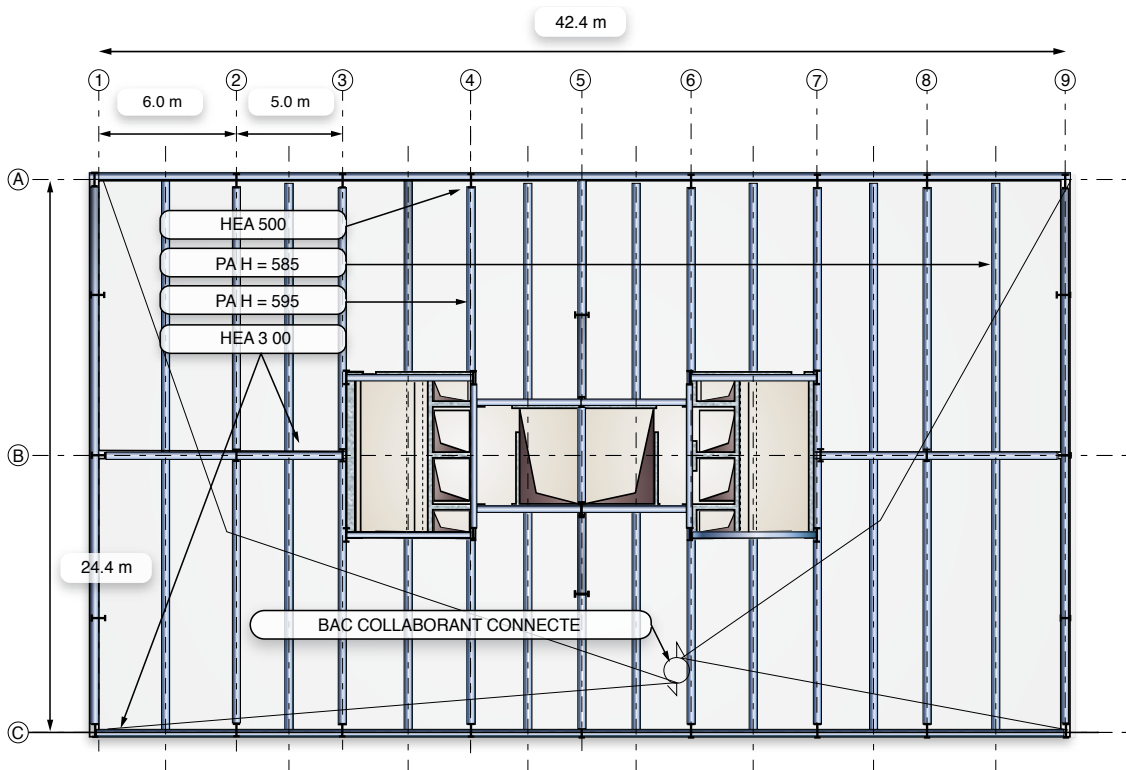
schéma en coupe d'un étage du bâtiment béton
